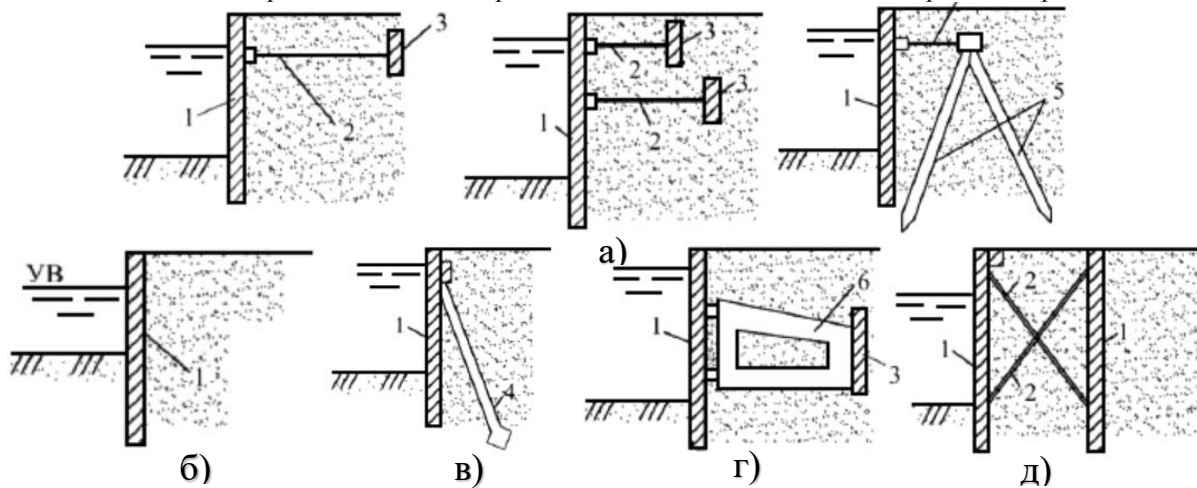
Гибкие анкеры: а – заанкеренные одной или двумя тягами к плитам и сваям, б – безанкерные, в – заанкеренные к наклонным сваям, г – заанкеренные с жестким (в том числе скользящим) анкерным устройством, д – в виде взаимно заанкеренных шпунтовых стен.
